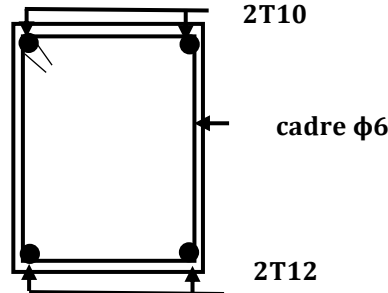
Schéma de ferrailage de la poutre palière(var2)
